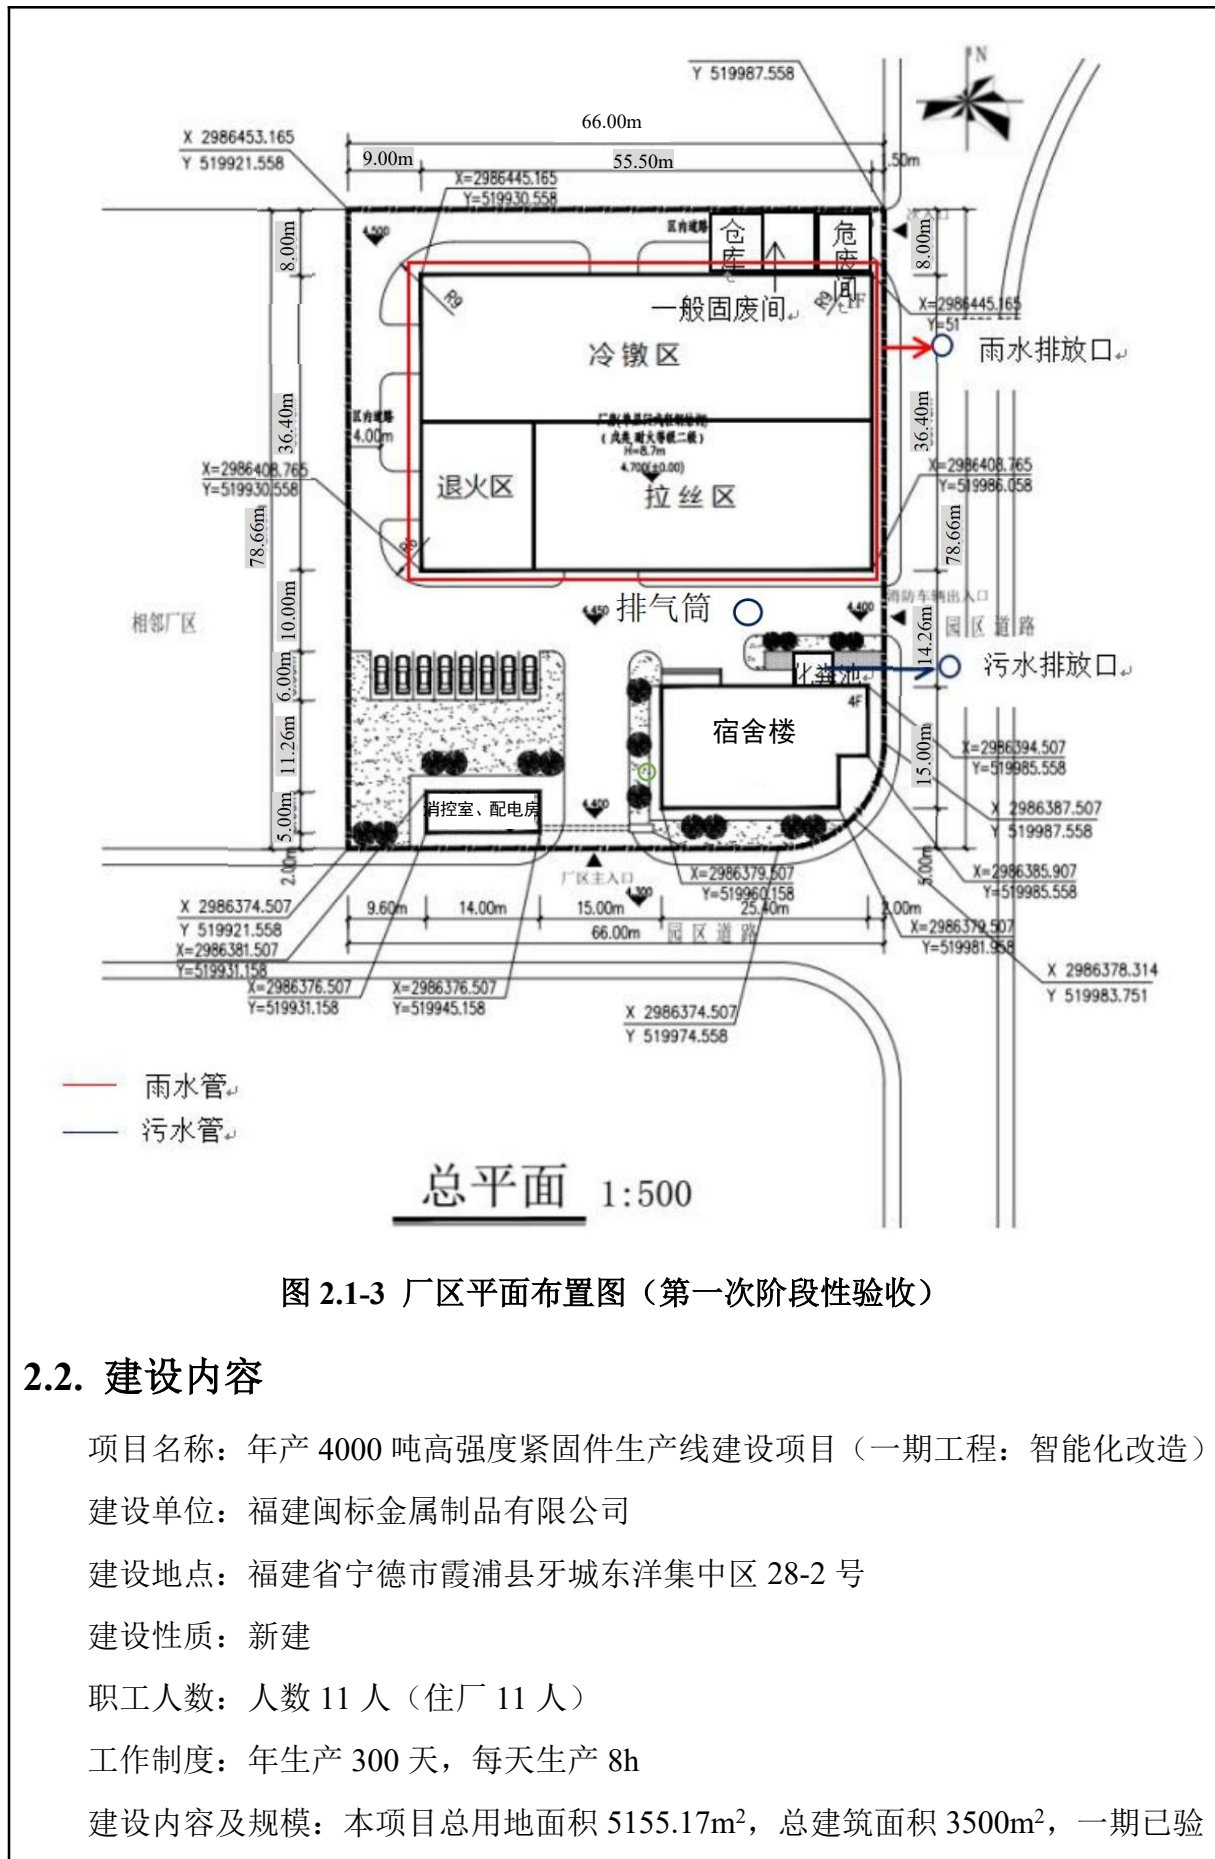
厂区平面布置图（第一次阶段性验收）
